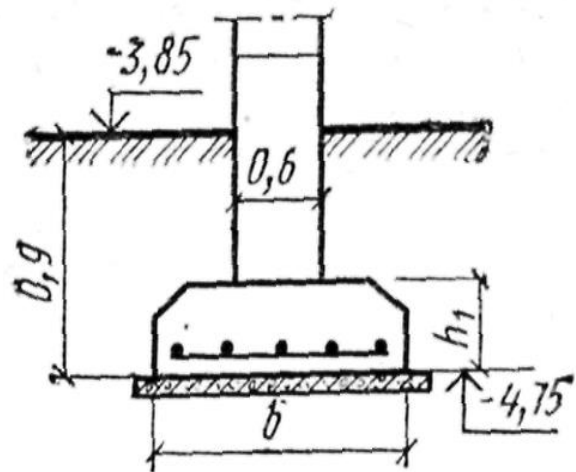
Фундамент зовнішньої стіни в безпідвальній частині будівлі
